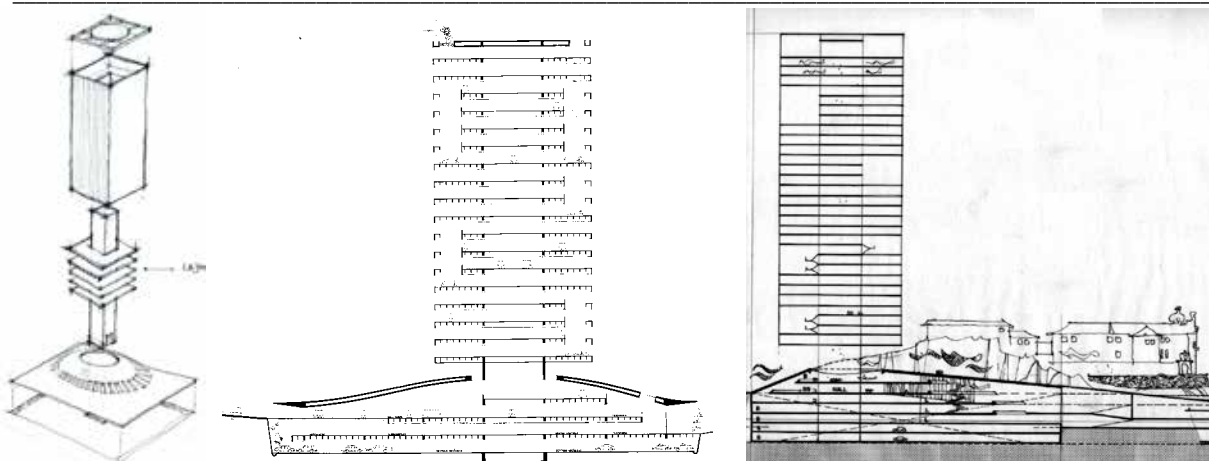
2º prêmio concurso BNDE DF (1973); esquema estrutural baseado em pilone central e lajes tipo em balanço.
